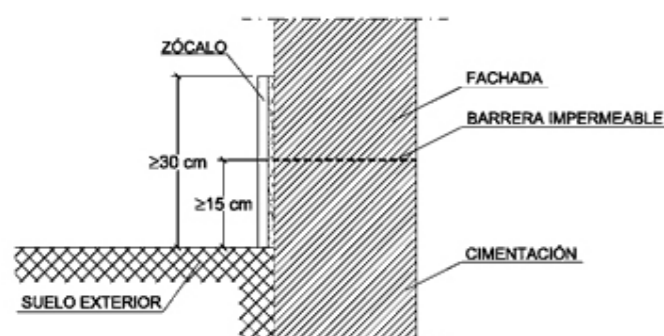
Ejemplo de arranque de la fachada desde la cimentación
